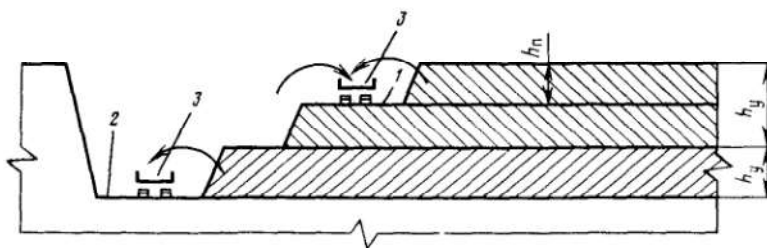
Поперечний переріз кар'єру: 1 – робоча площадка верхнього уступу; 2 – робоча площадка нижнього уступу; 3 – транспортні засоби
